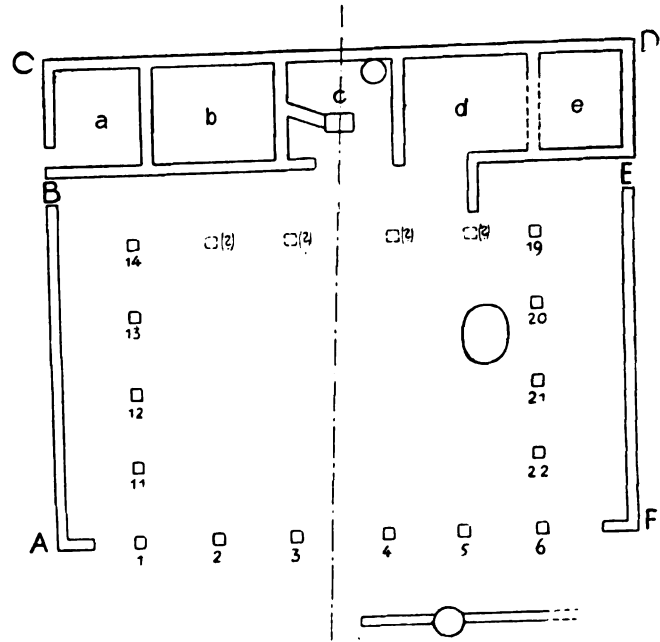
Prætorium, Skizze zum Grundriss der älteren Anlage (1:300).
